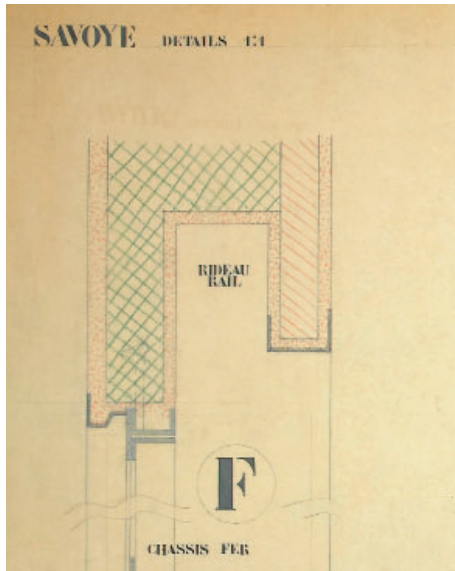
Sección "F" del plano de detalles de la *Villa Savoye* a escala 1:1, Atelier LC-PJ, 13-5-1929. FLC 19452 (pormenor 1).
